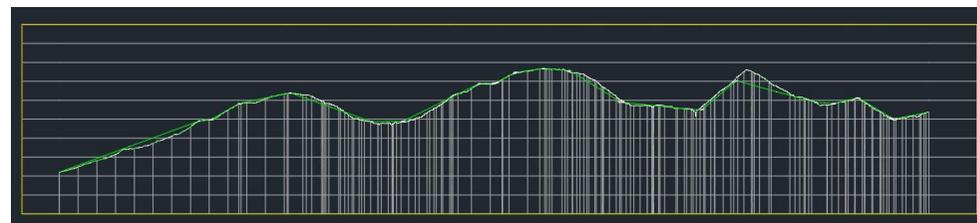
Diagrama de trazado en alzado. Fuente: Elaboración propia.
